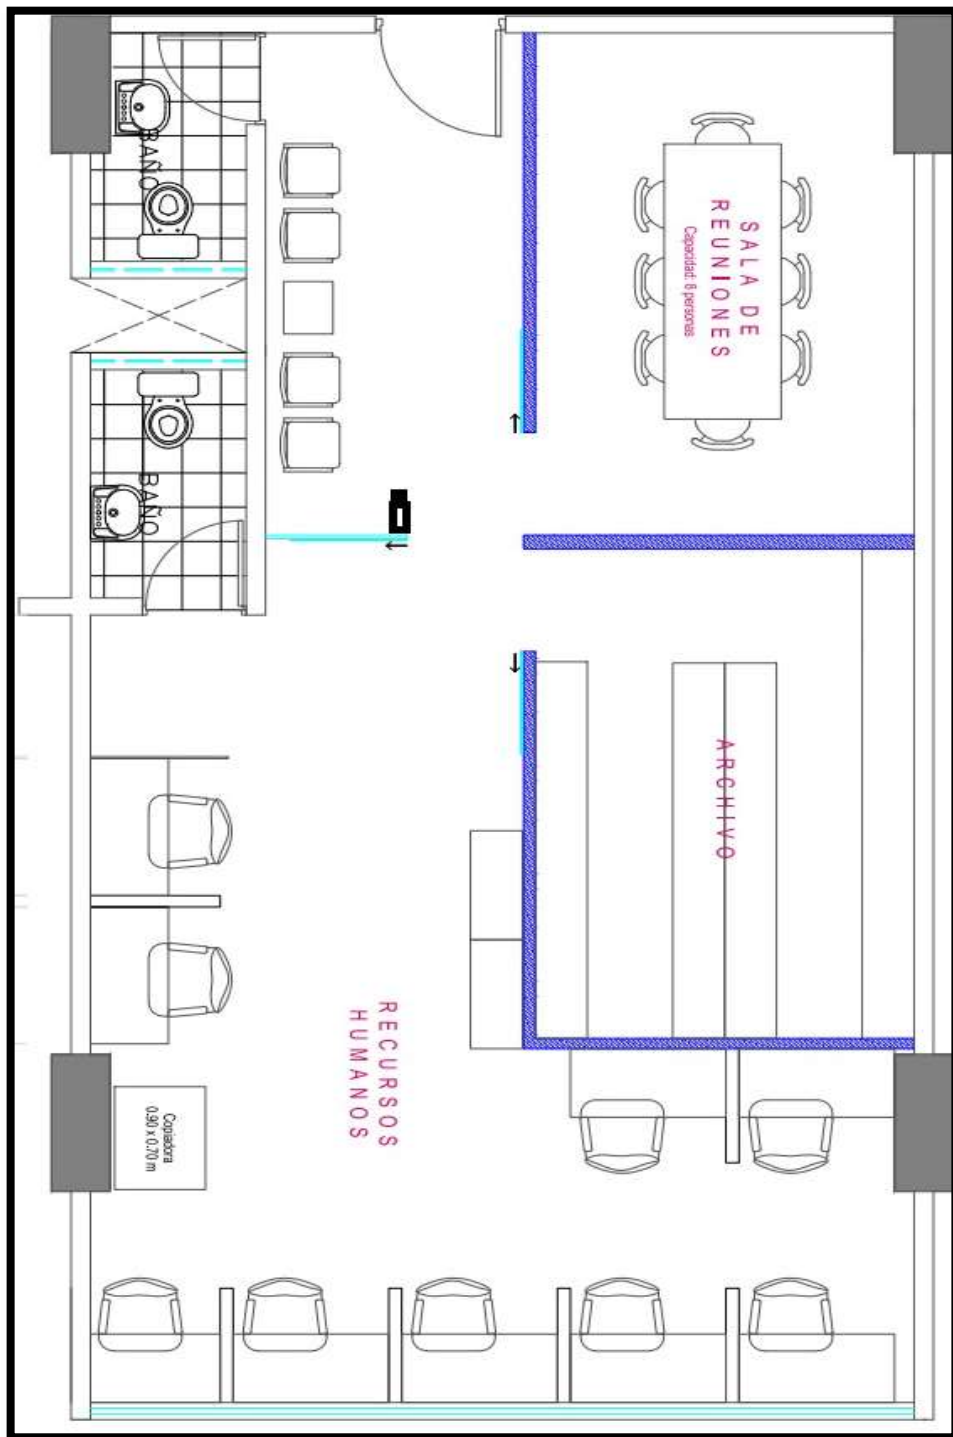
Plano de distribución de oficinas y área 9009.
